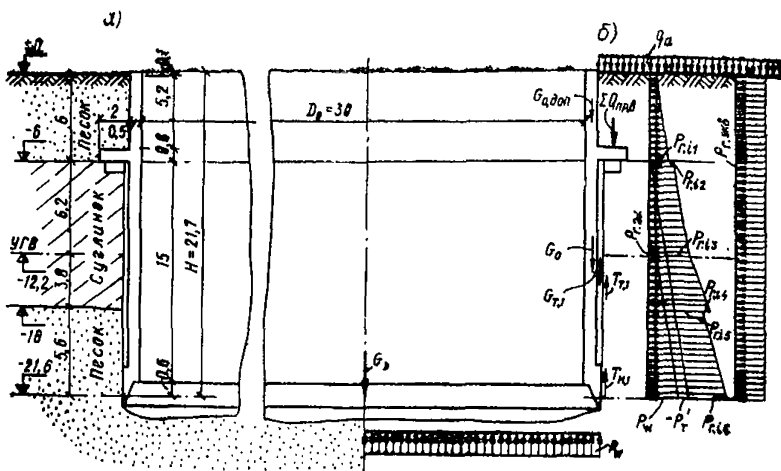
Схема круглого колодца (а) с расчетными нагрузками (б) в условиях строительства, после изготовления дна
